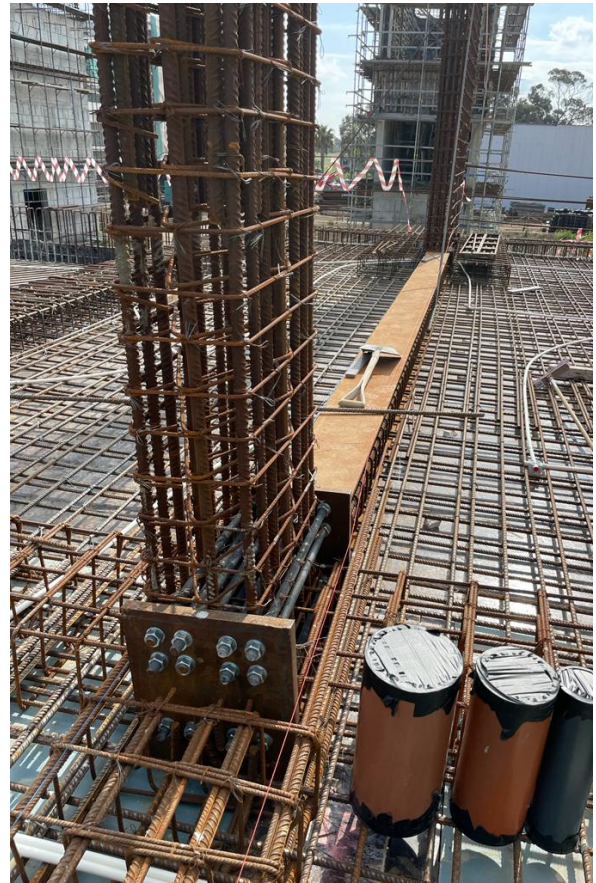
Estructura mixta y Anclajes atravesando pilares de hormigón armado del CCB con placa postensada. Al fondo se ve el núcleo del DOT al que tiene que llegar la cercha del Bridging Truss.
